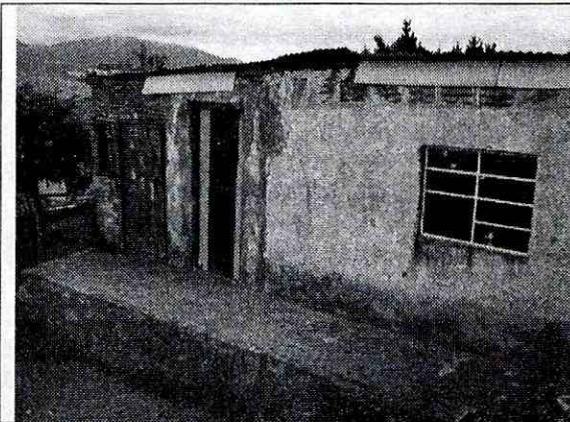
Vista general de la vivienda ubicada en la Calle 82A Sur # 18N-52, se presentan deficiencias constructivas, relacionadas con la carencia de elementos de confinamiento y amarre de tipo vigas y columnas.
